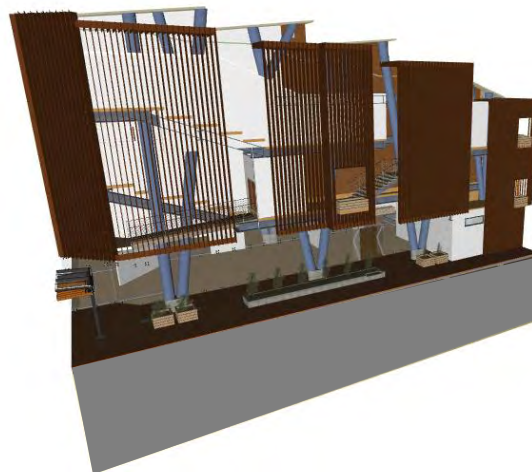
Fachada tridimensional. Fuente: Elaboración Propia.
